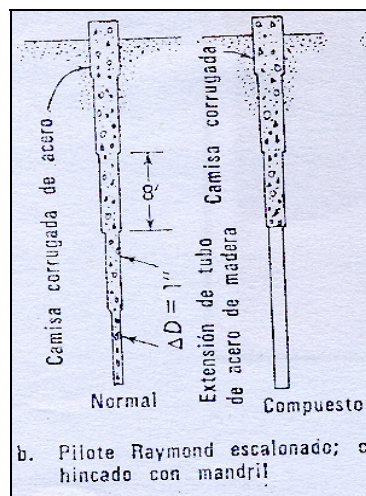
Pilote Raymond escalonado e hincado con mandril
